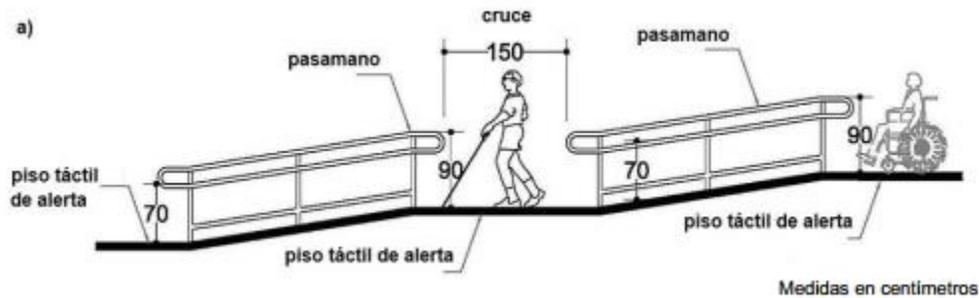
Vista en elevación frontal de rampa y de pasamanos central en donde se indica el espacio para el cambio de carril de cada descanso. Fuente: CONAIPD
